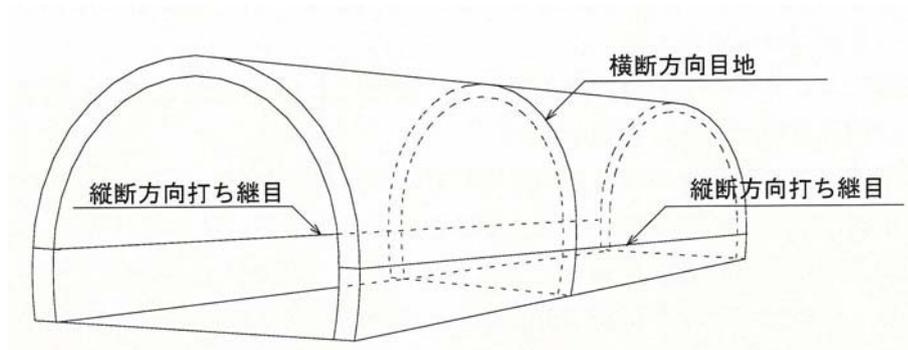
覆工コンクリートの目地と継目付近のひび割れ
